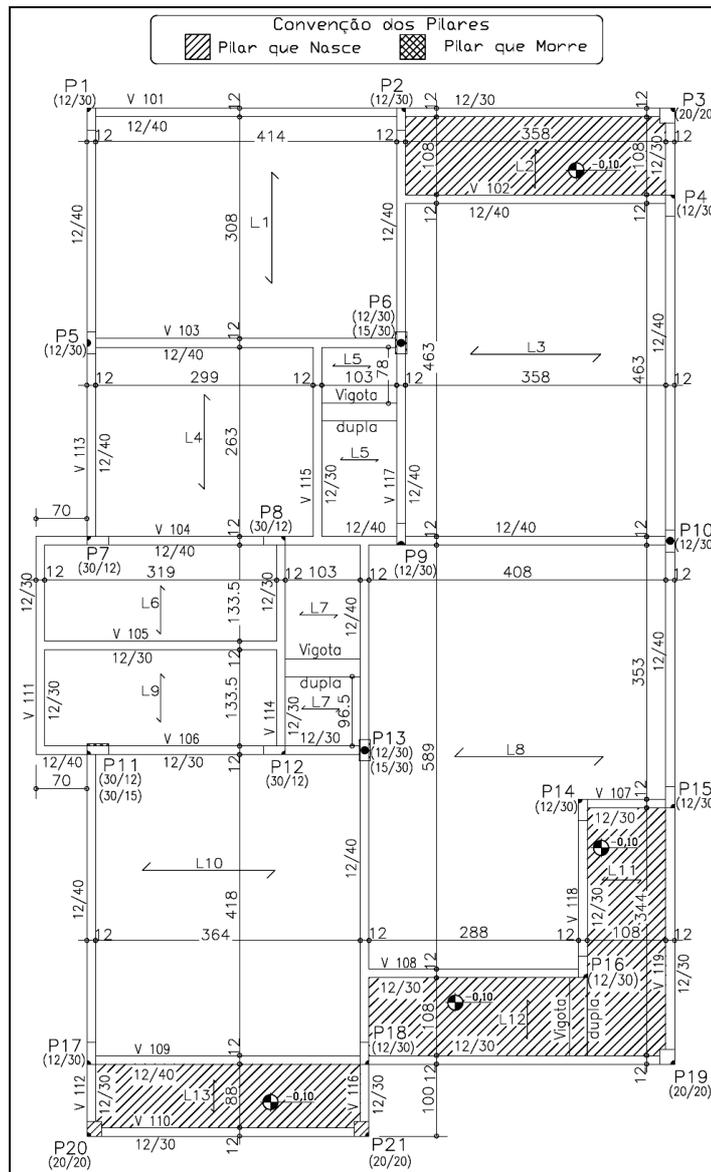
Planta de fôrmas da estrutura PROJETADA
